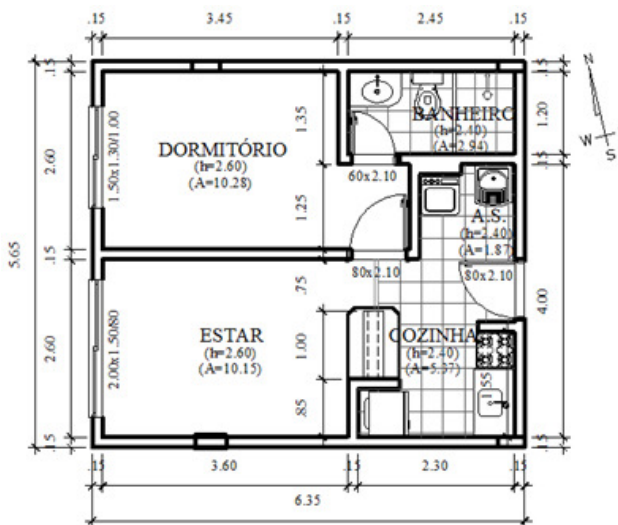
Planta baixa da Habitação B, com área útil de 30,61m² e tipologia 4.
